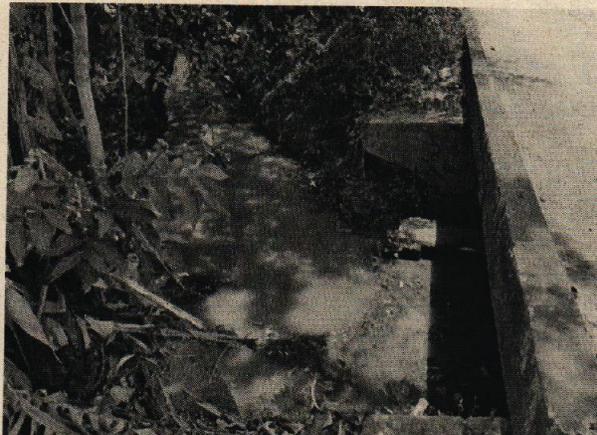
En este registro se aprecia el zanjón Guali sobre la doble calzada Zarzal Tuluá en el sentido Norte sur.
